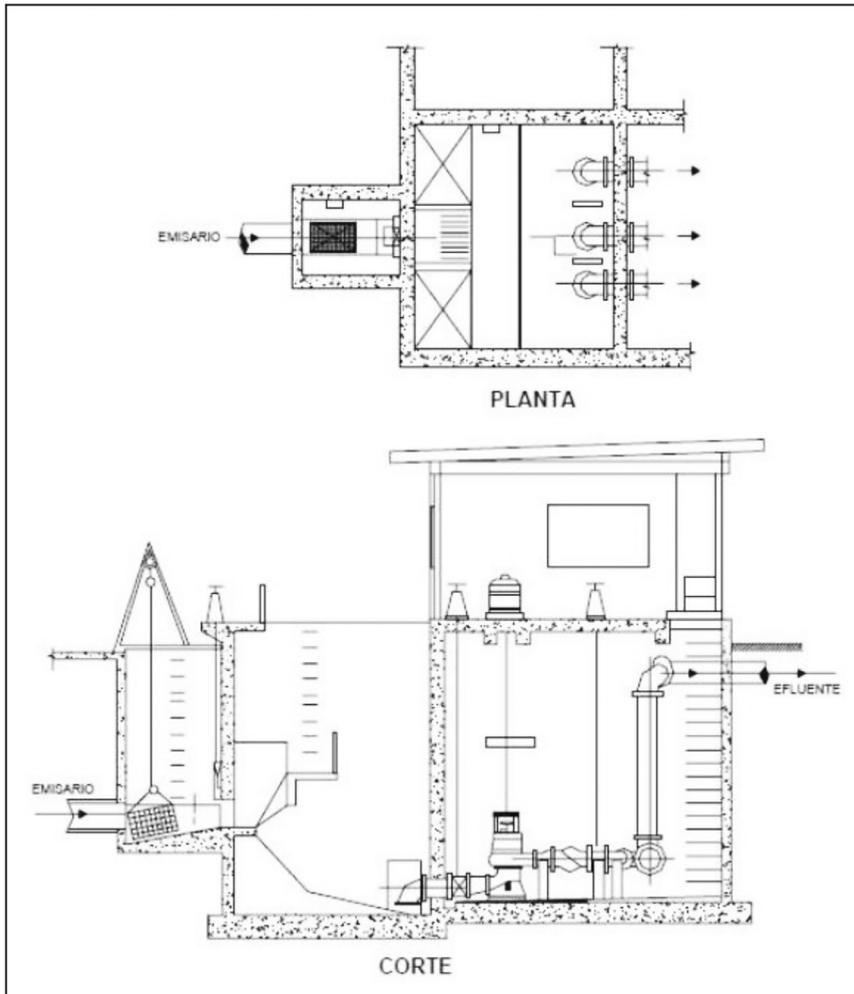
Estación de bombeo tipo. Bomba de eje vertical en pozo seco. Planta y corte.
